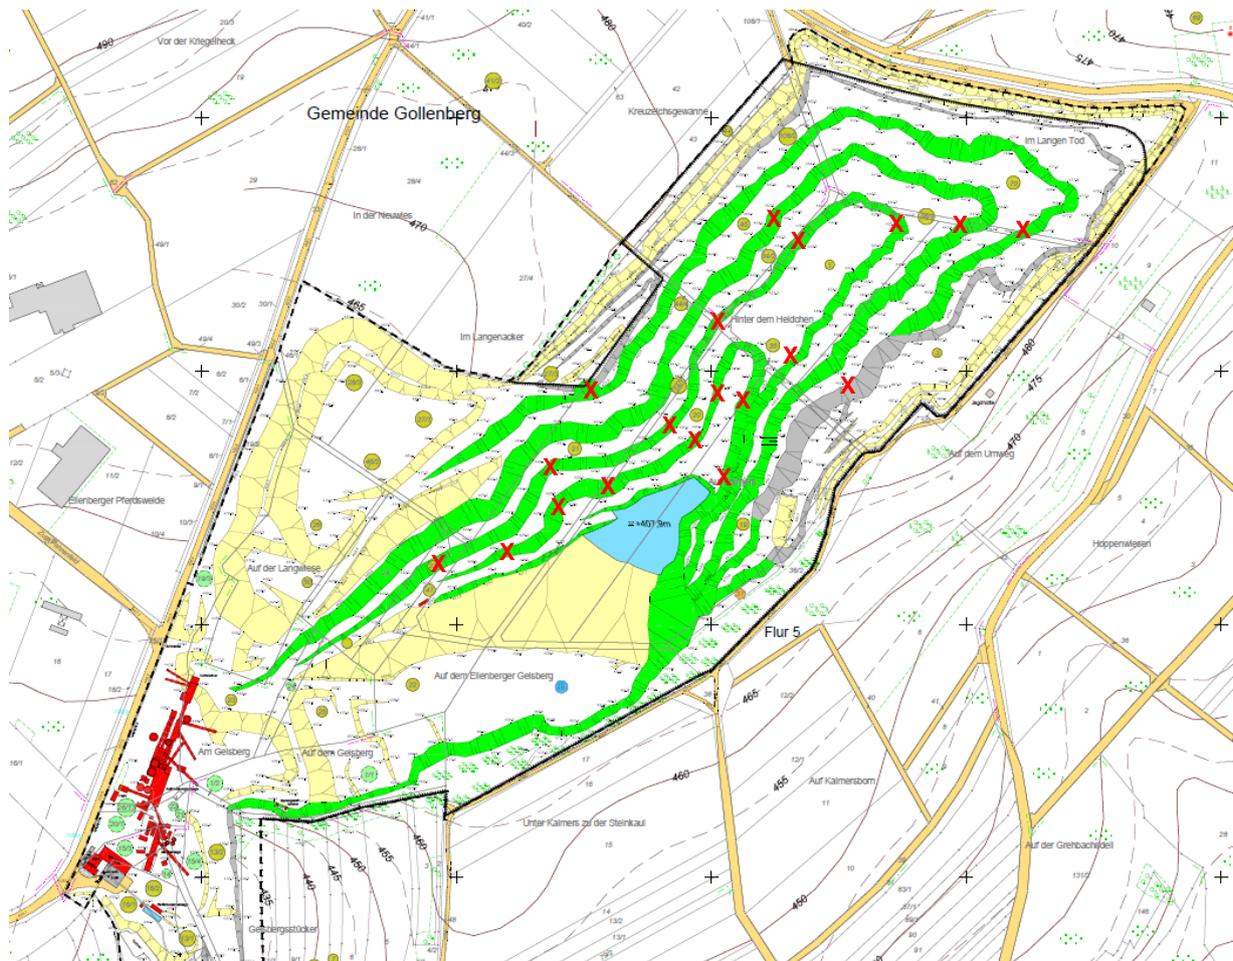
Lageplan Tagebau Ellenberg mit Eintragung der Aufnahmepunkte (o.M.)
